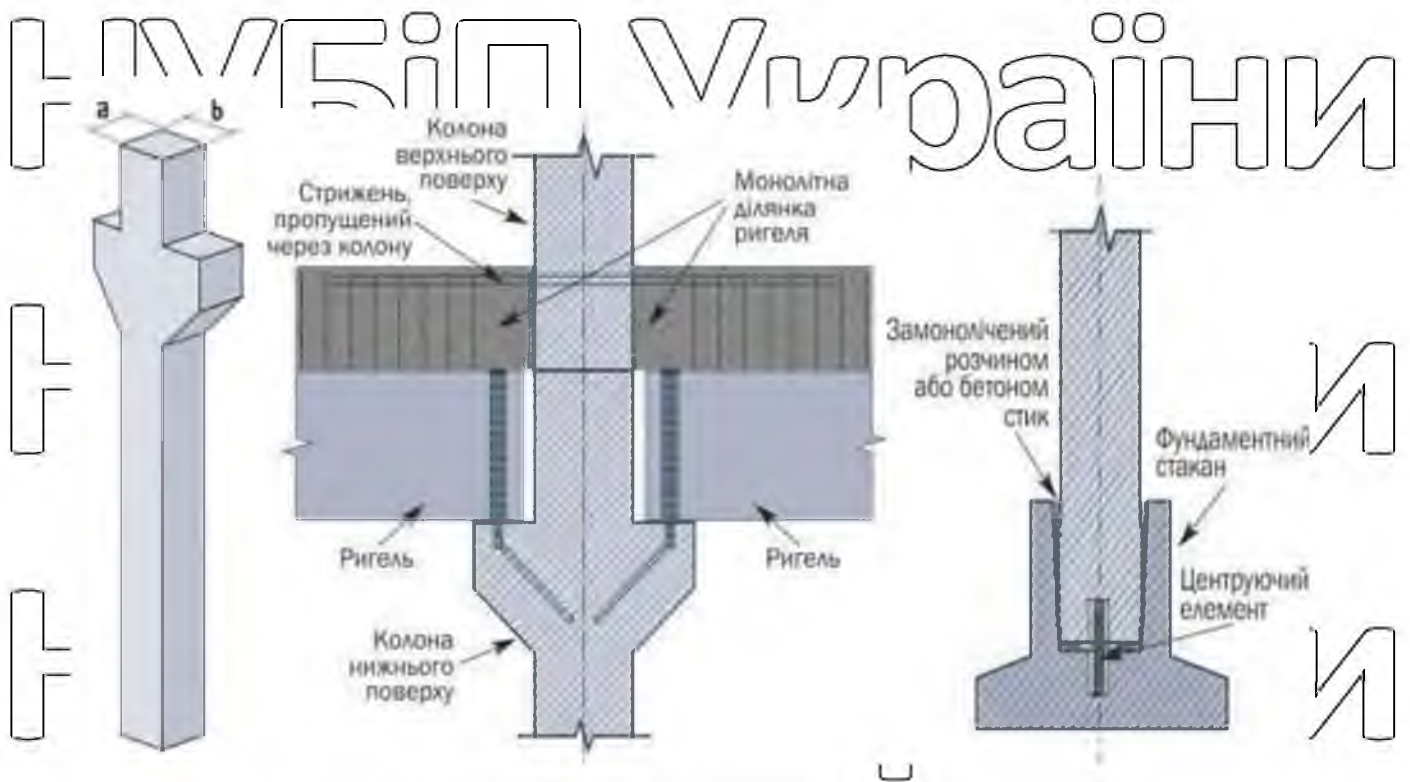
Збірна залізобетонна колонна консольного типу
